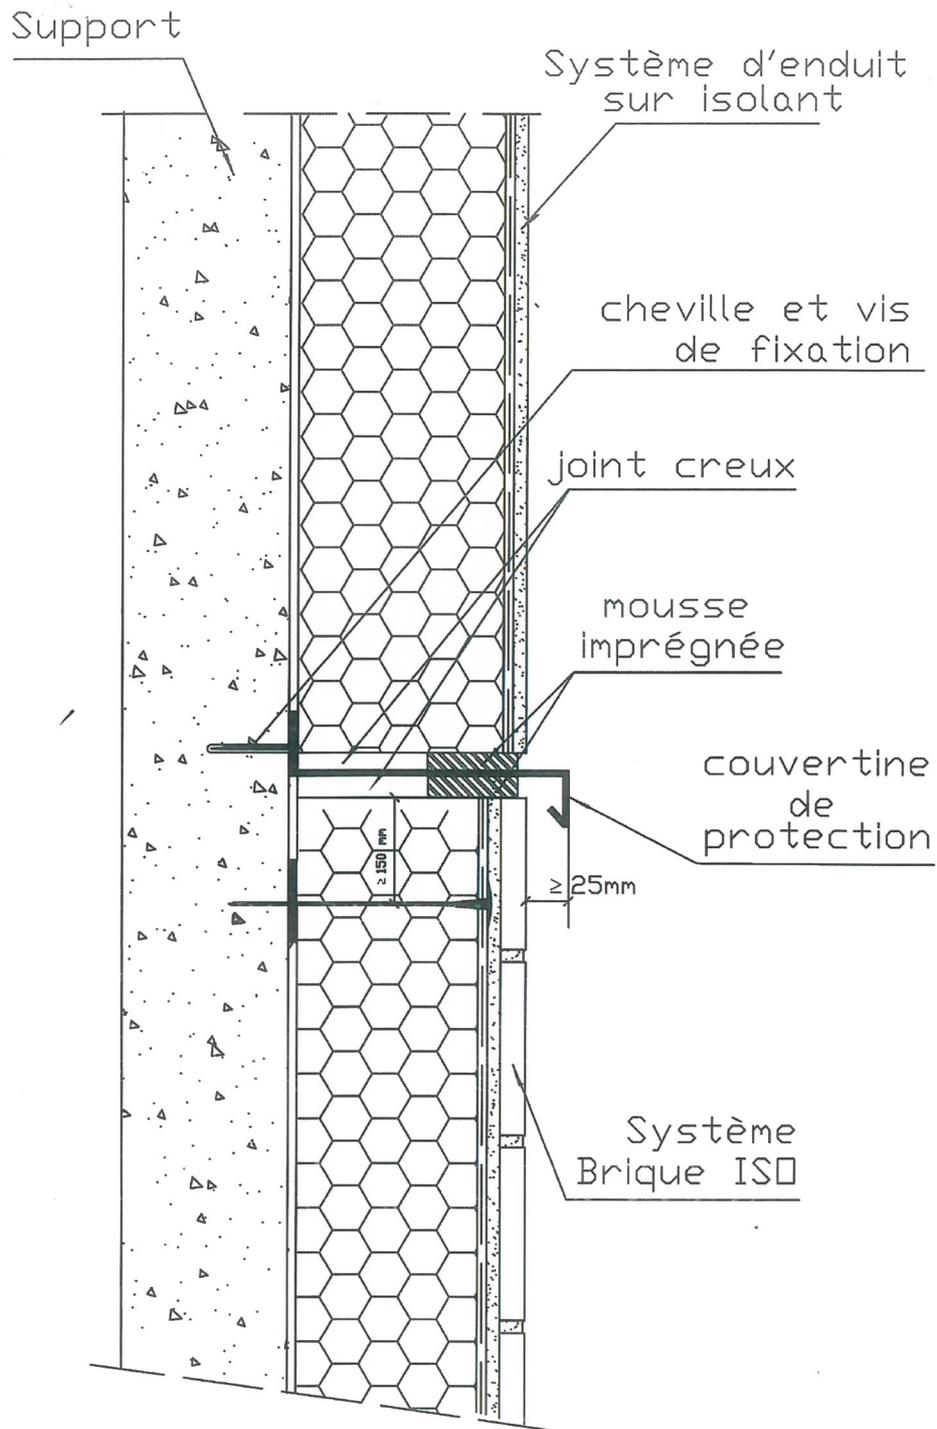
Raccordement avec un système d'enduit sur isolant / utilisation d'une bavette
